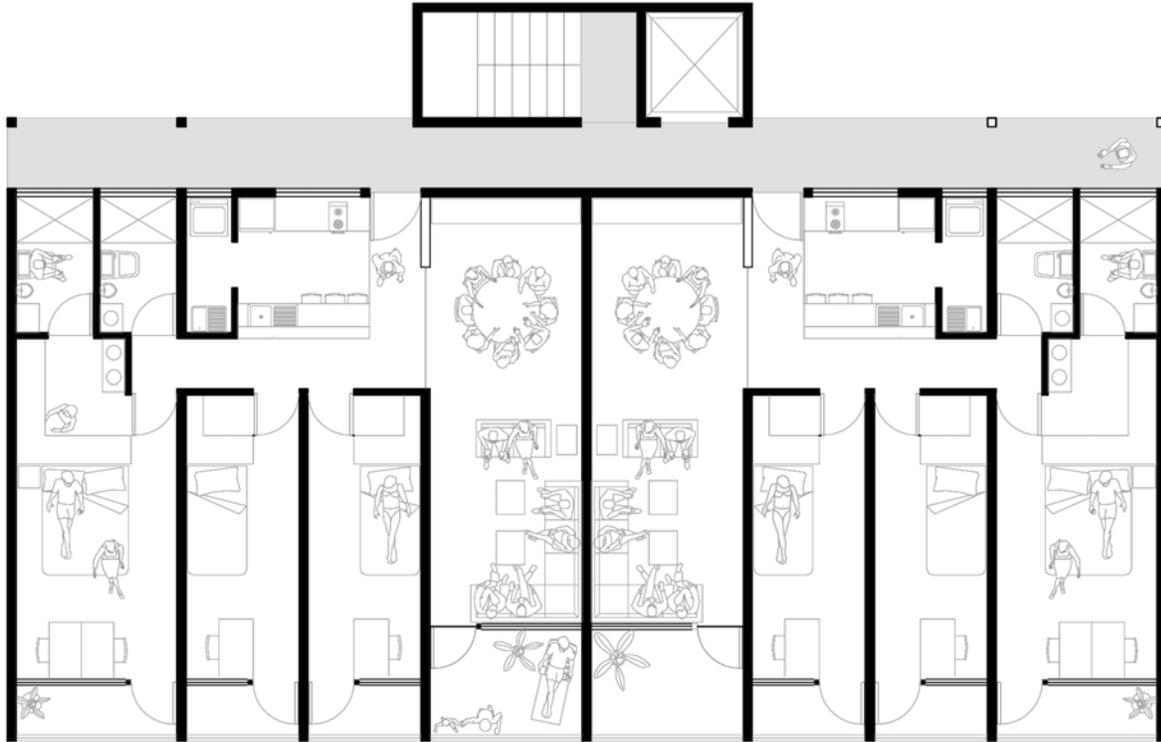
Módulo Privado. Fuente: Propuesta arquitectónica del autor
